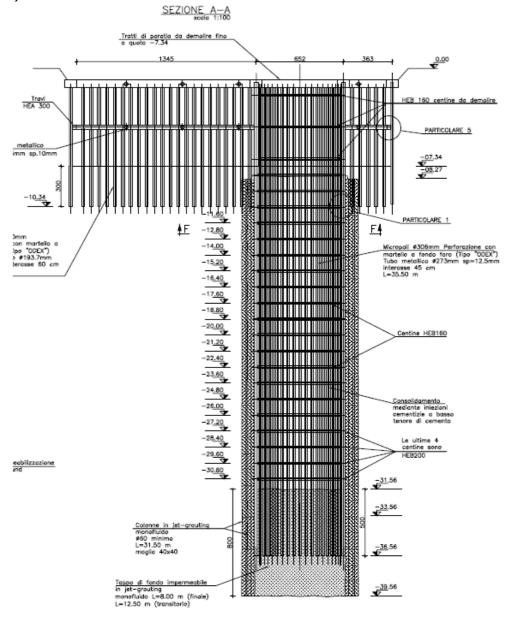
Esempio di opere di contenimento degli scavi per pozzo verticale – Sezione Tronchino di collegamento tra pozzo e galleria di linea
